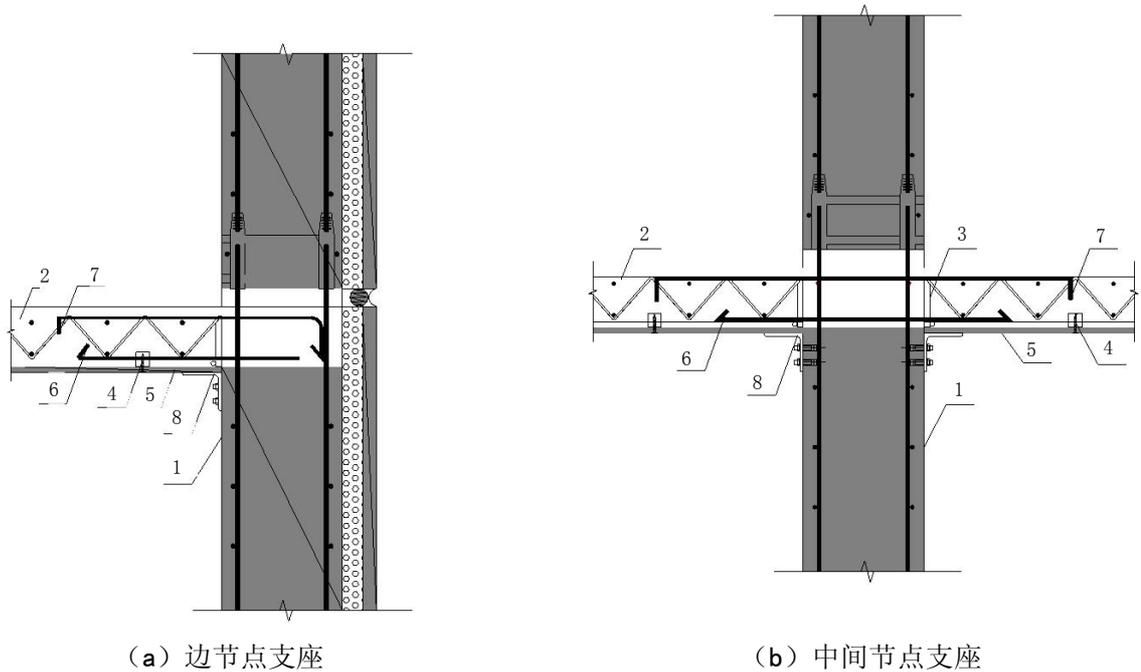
竹基底模楼承板与预制混凝土剪力墙支座连接构造示意
